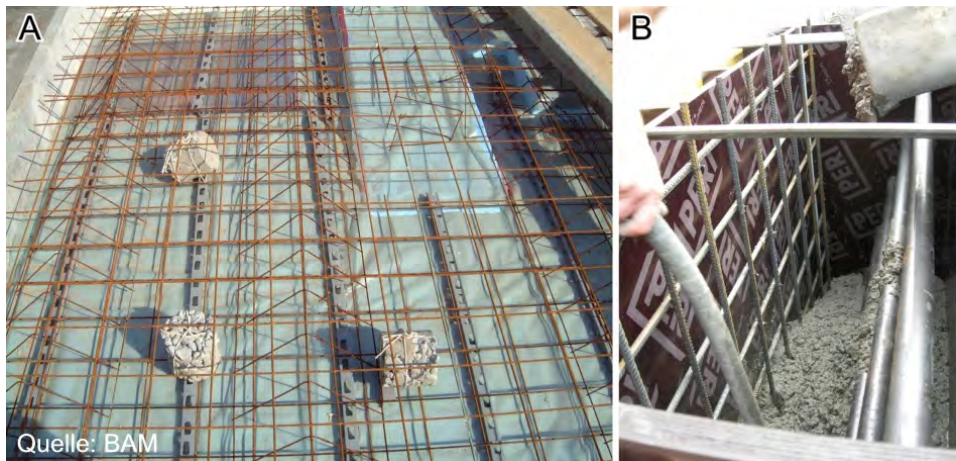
A: Bewehrungsmatten des großen Betonprobekörpers (GBP der BAM) mit unterschiedlichem Bewehrungsgehalt, Bauteildicken und künstlich eingebauten Fehlstellen vor der Betonage.
